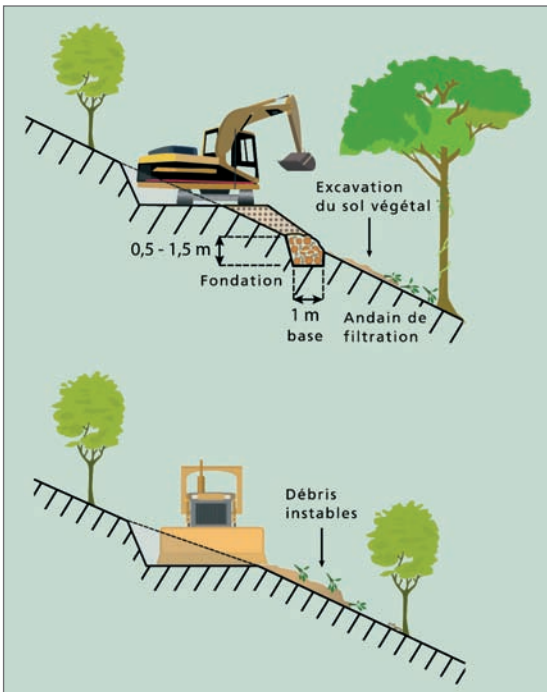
Construction de route à l'aide d'une pelle hydraulique et d'un tracteur à chenilles
